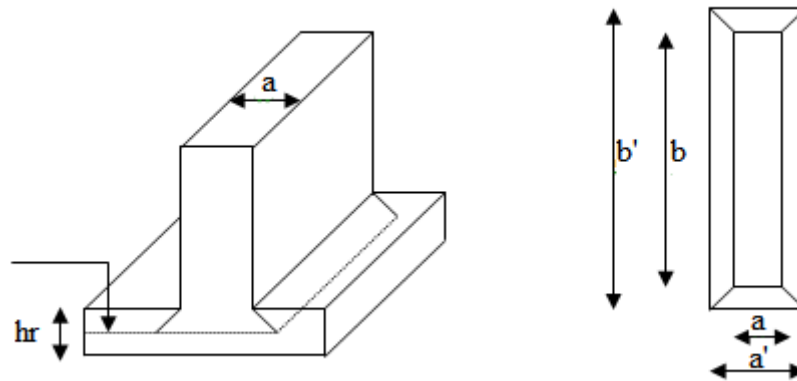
Surface d'impact projetée sur le plan moyen du radier
